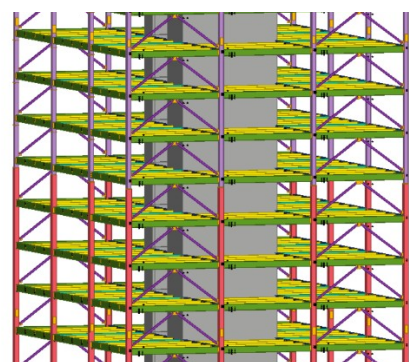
Detalhe Pavimentos Lajes Steel Deck
